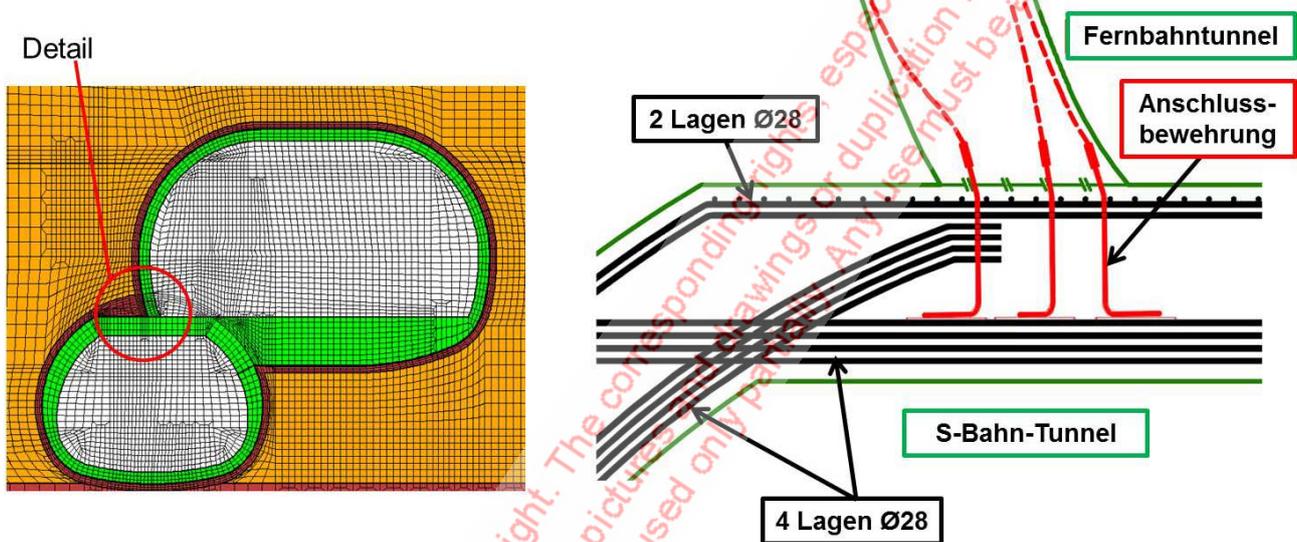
Bewehrung S-Bahn-Tunnel mit Anschluss an Ulme Fernbahntunnel
